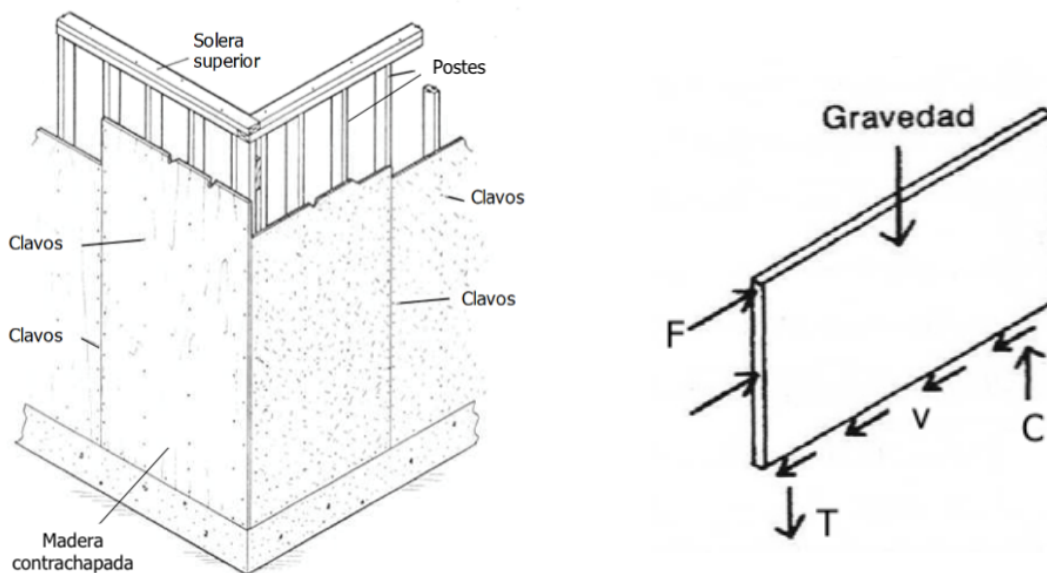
Elementos dentro de un muro estructural de madera (izq.),
